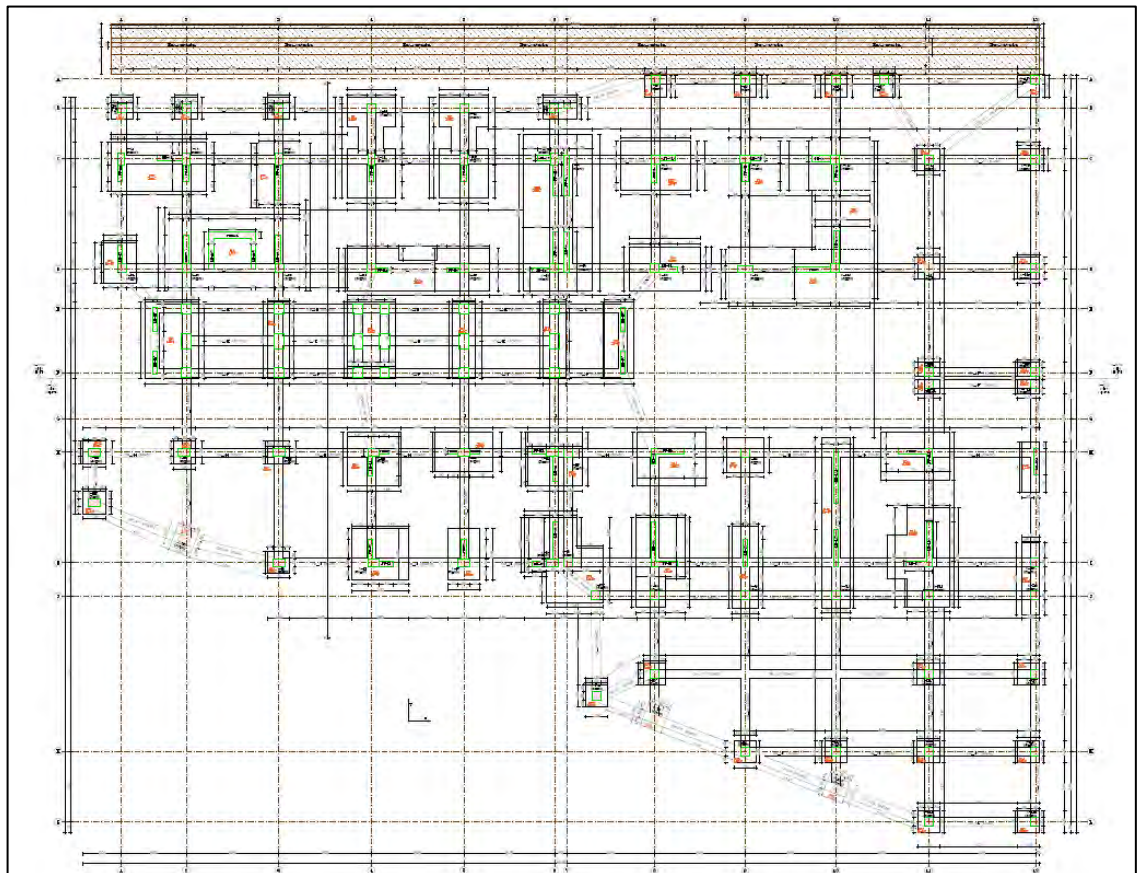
Planta estructural de cimentación Bloque I – Sur. (Ver Anexo B)
